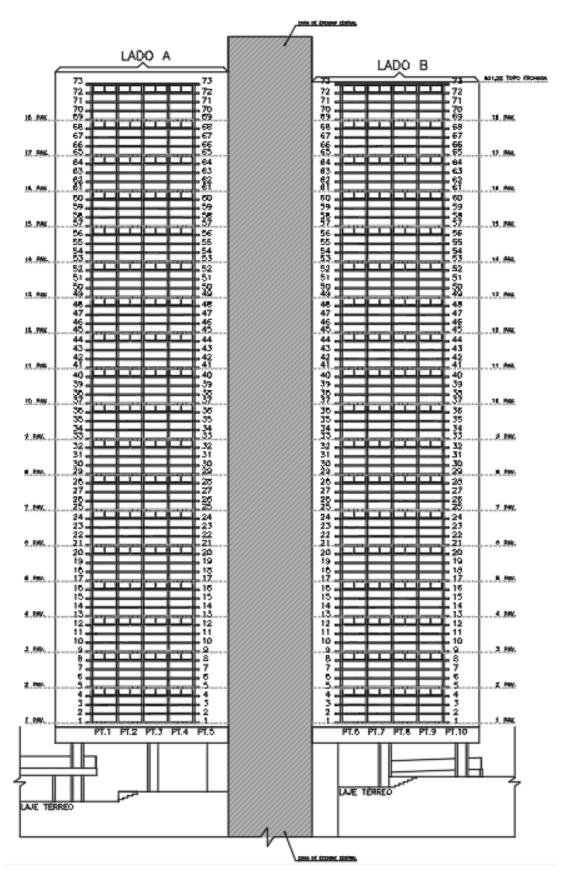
Elevação esquemática com a numeração dos brises e lados.
